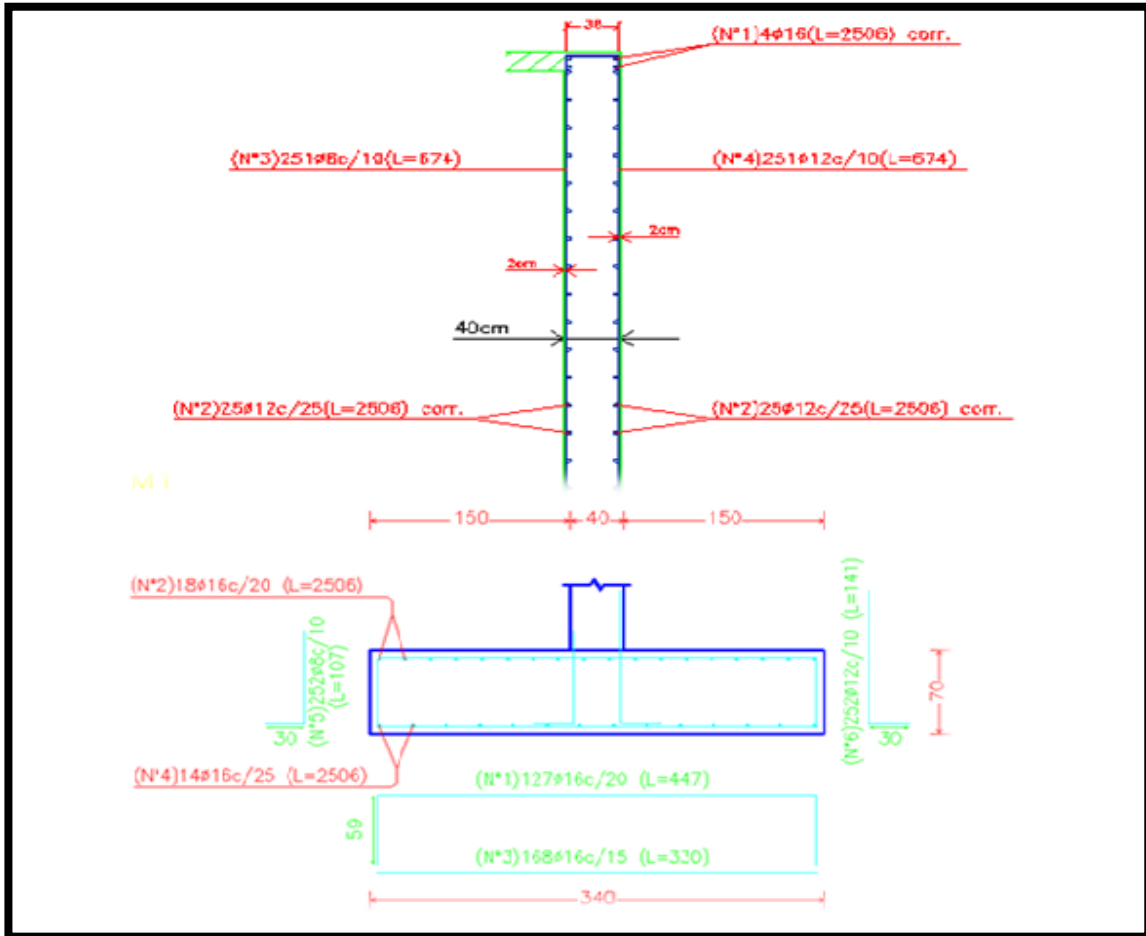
Armado de muro de contencion, Elaboracion propia
